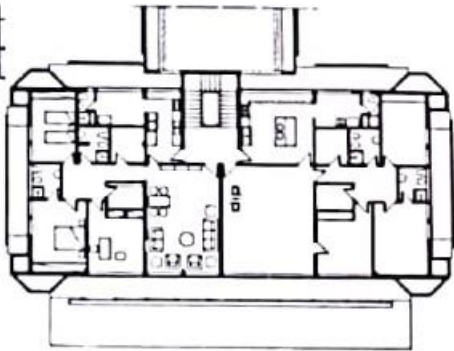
Planta baixa do segundo pavimento, que abriga apartamentos temporários para diplomatas no edifício da Chancelaria. Fonte: Revista Projeto.
